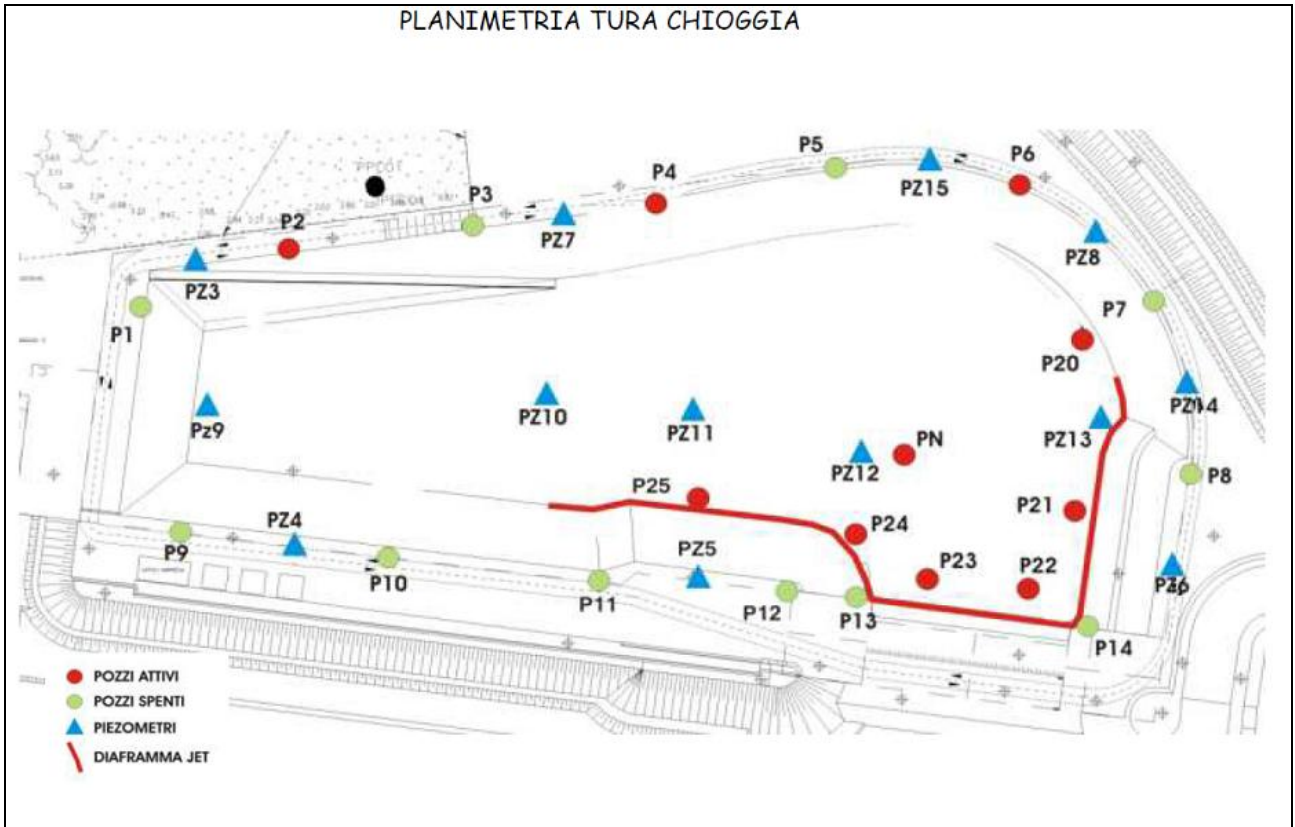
Planimetria del sistema di dewatering della tura (fonte: Consorzio Venezia Nuova).
